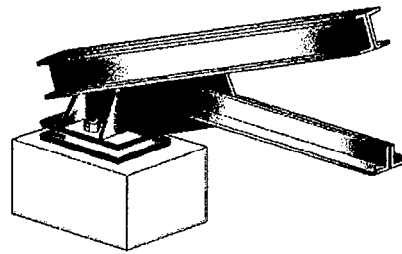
80: Apoyo anclado en columna de concreto, caso más común.
